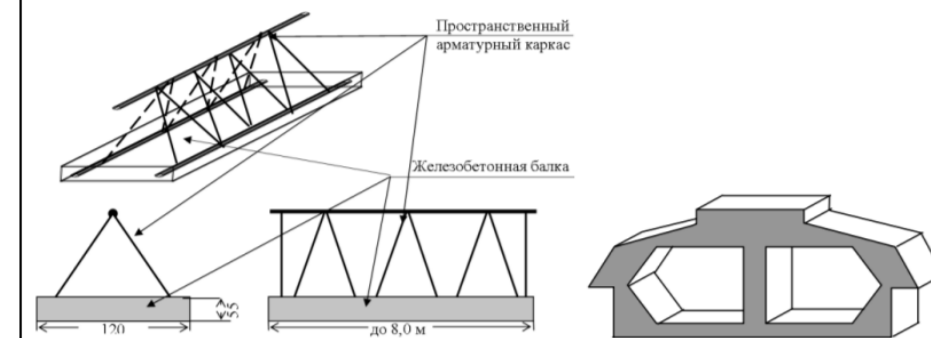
Монтажный железобетонный прогон на керамзитобетонный пористый блок збірно-монолітного перекриття «ALBERT»
